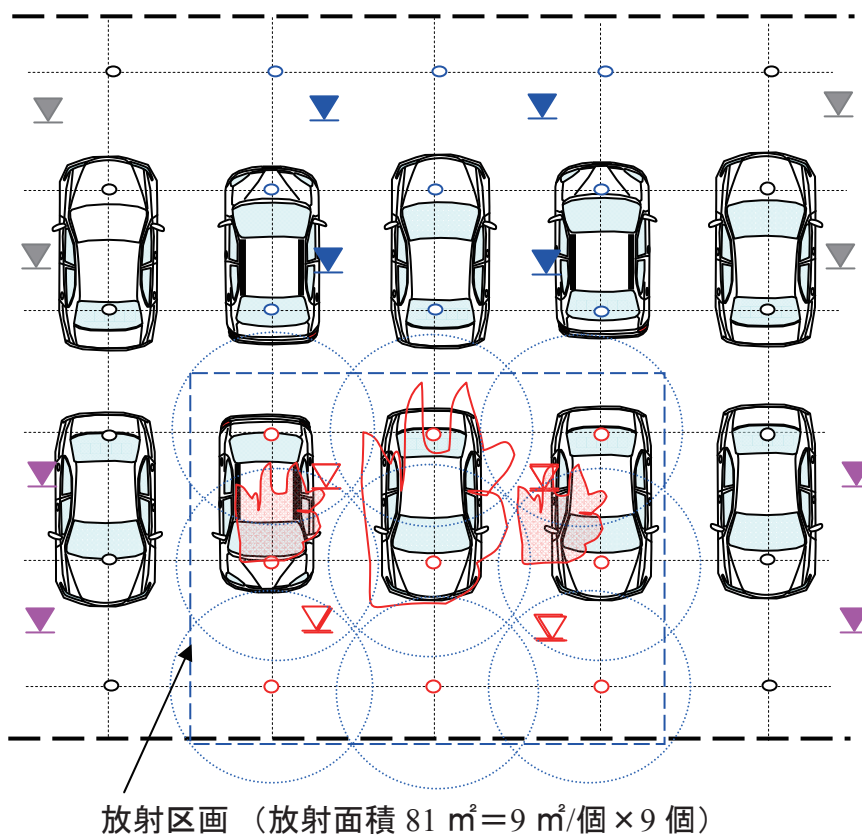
平面駐車場での泡消火設備の消火状況(泡放射の平面図)
